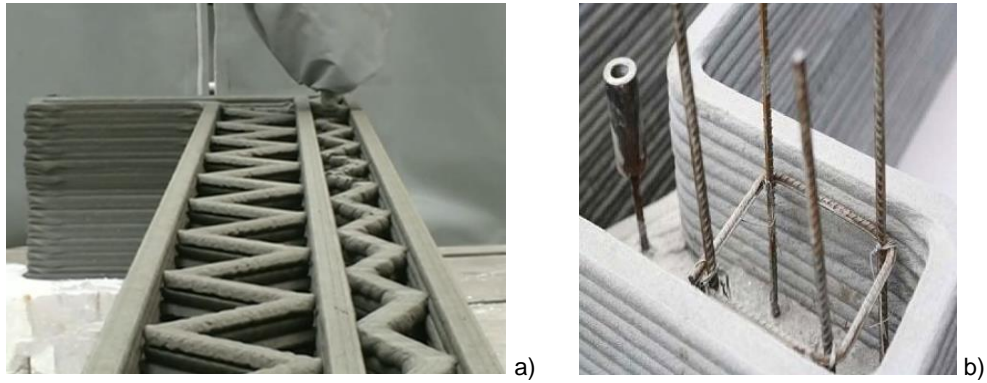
a) Reforço com padrão diagonal [98], b) Reforço com armadura metálica [99]
